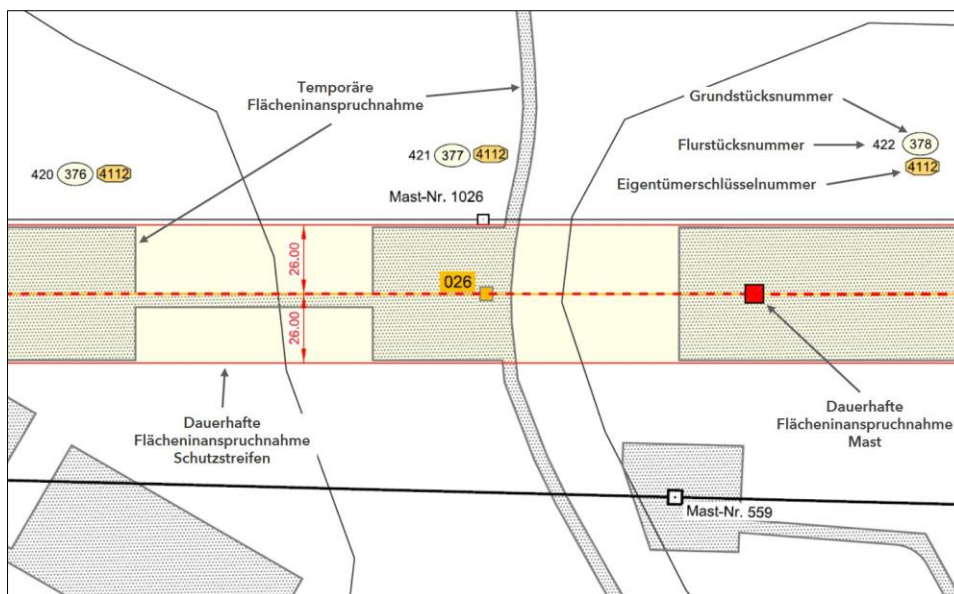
Dauerhafte und temporäre Flächeninanspruchnahme (Ausschnitt Grunderwerbsplan)
